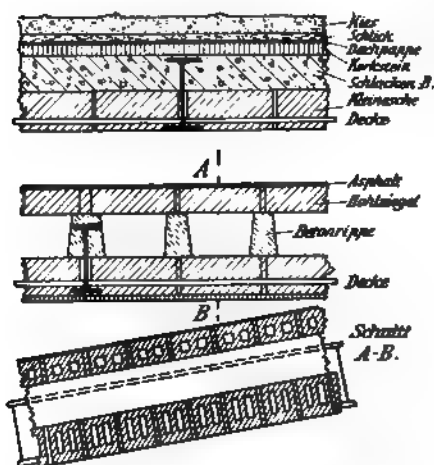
u. 12. Kleinsche Decke mit Schlackenbetonfüllung (oben) und besonderen Hohlräumen (unten).
